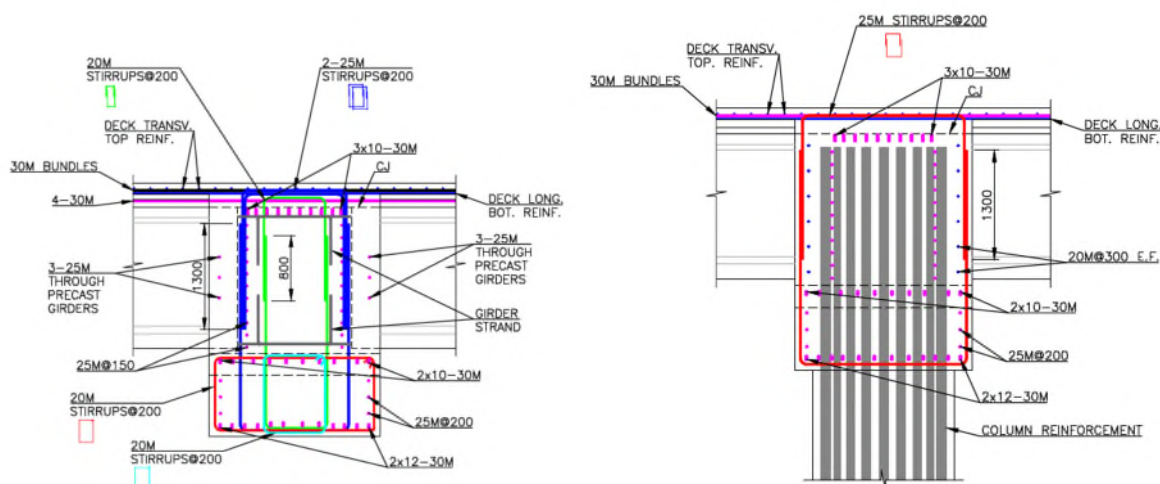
Detalle de continuidad entre dinteles, vigas y pilas.
